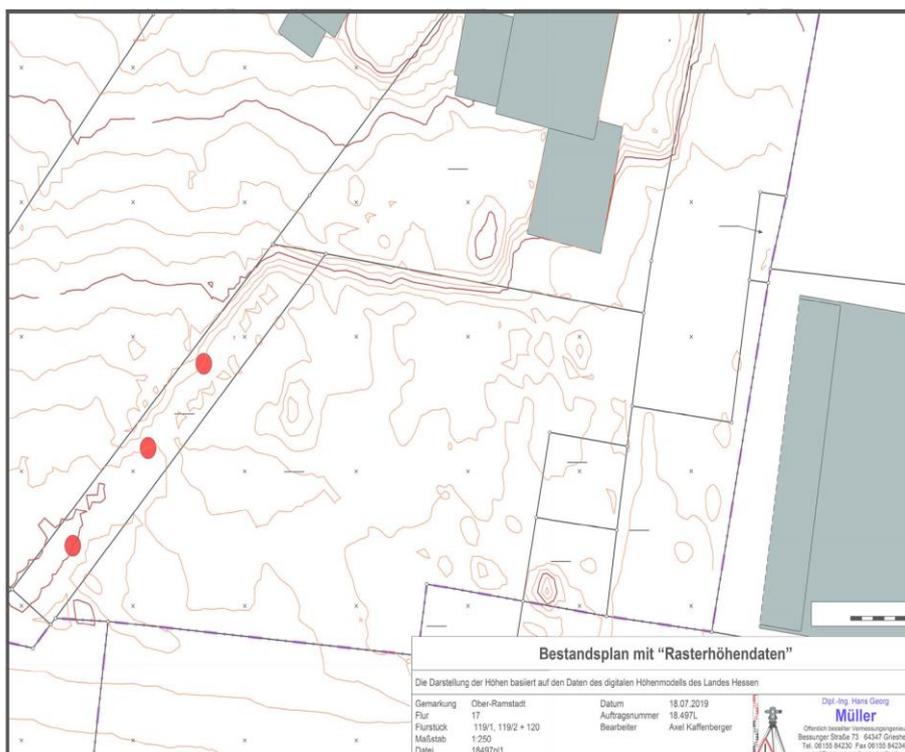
Lageplan mit Bohransatzpunkten, KAT Umweltberatung GmbH, 2020
